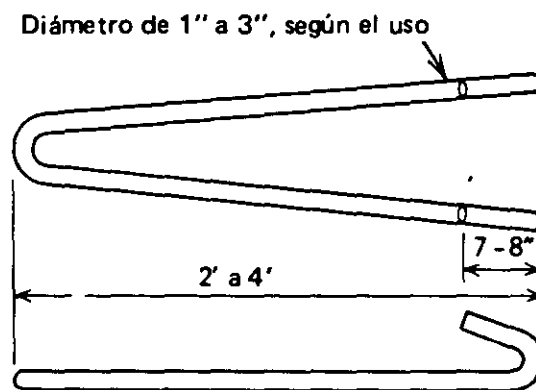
Ancla tipo horquilla (para concreto).
